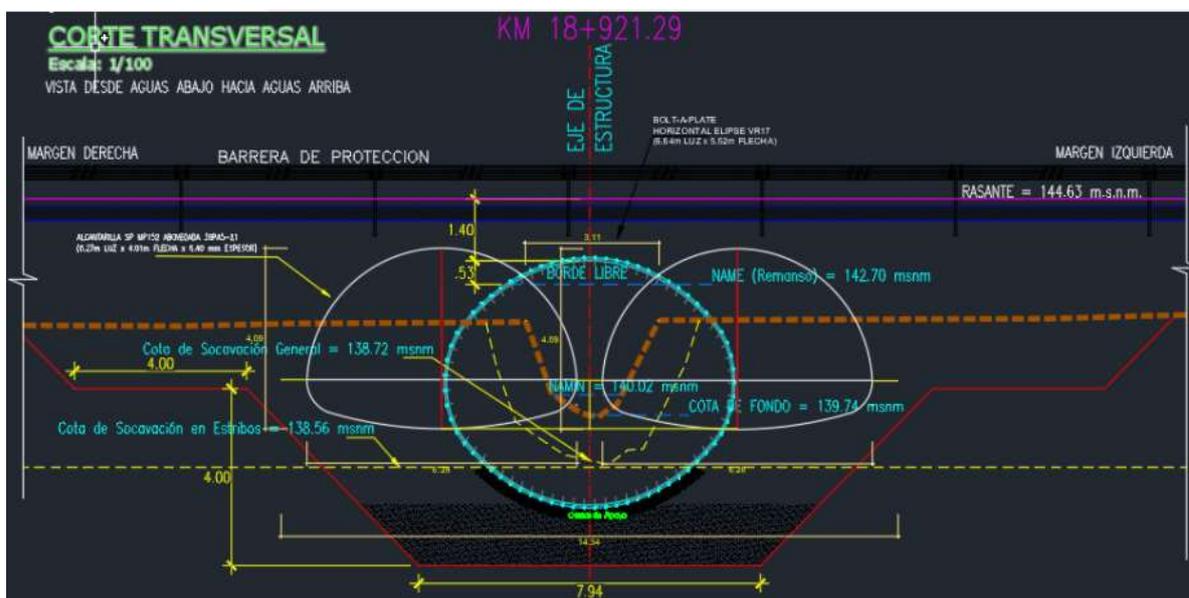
Detalles Alcantarilla Metálica Corrugada Tipo MP-152
